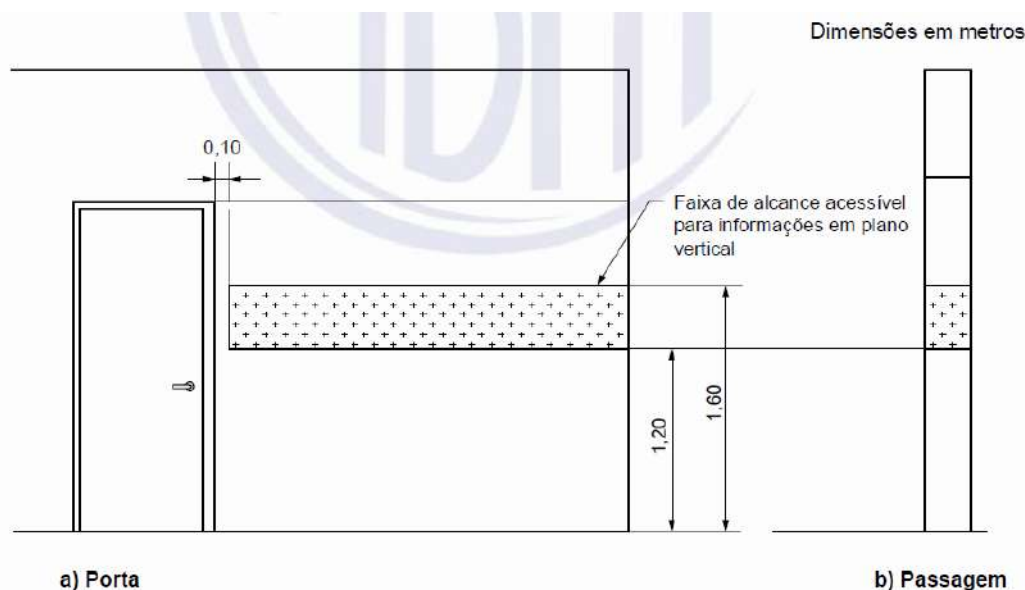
Sinalização de portas e passagens – Faixa de alcance acessível
